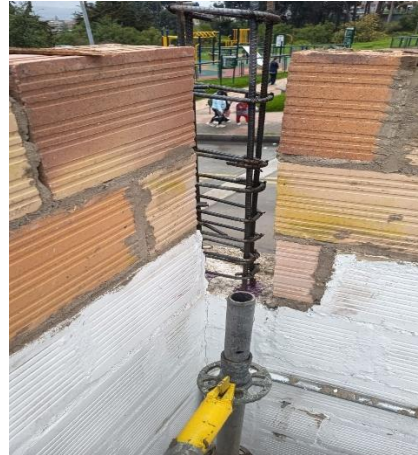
Muro divisorio bloque estirado No. 5.
